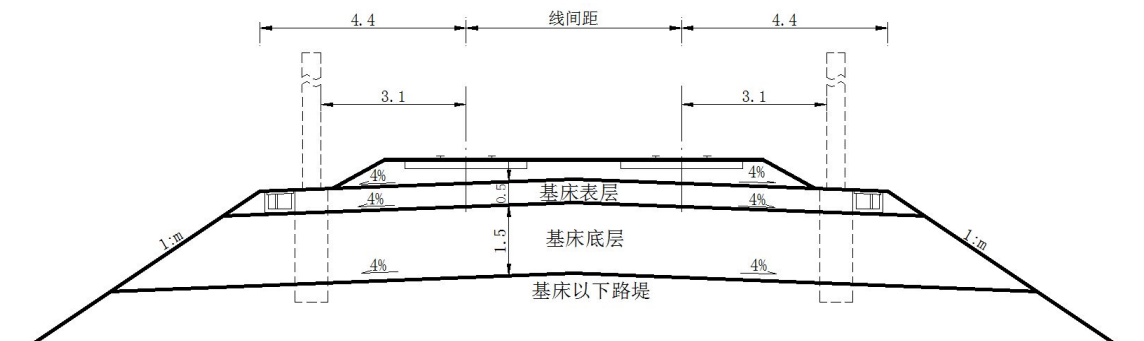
有砟轨道双线路堤横断面示意图（单位：m）
